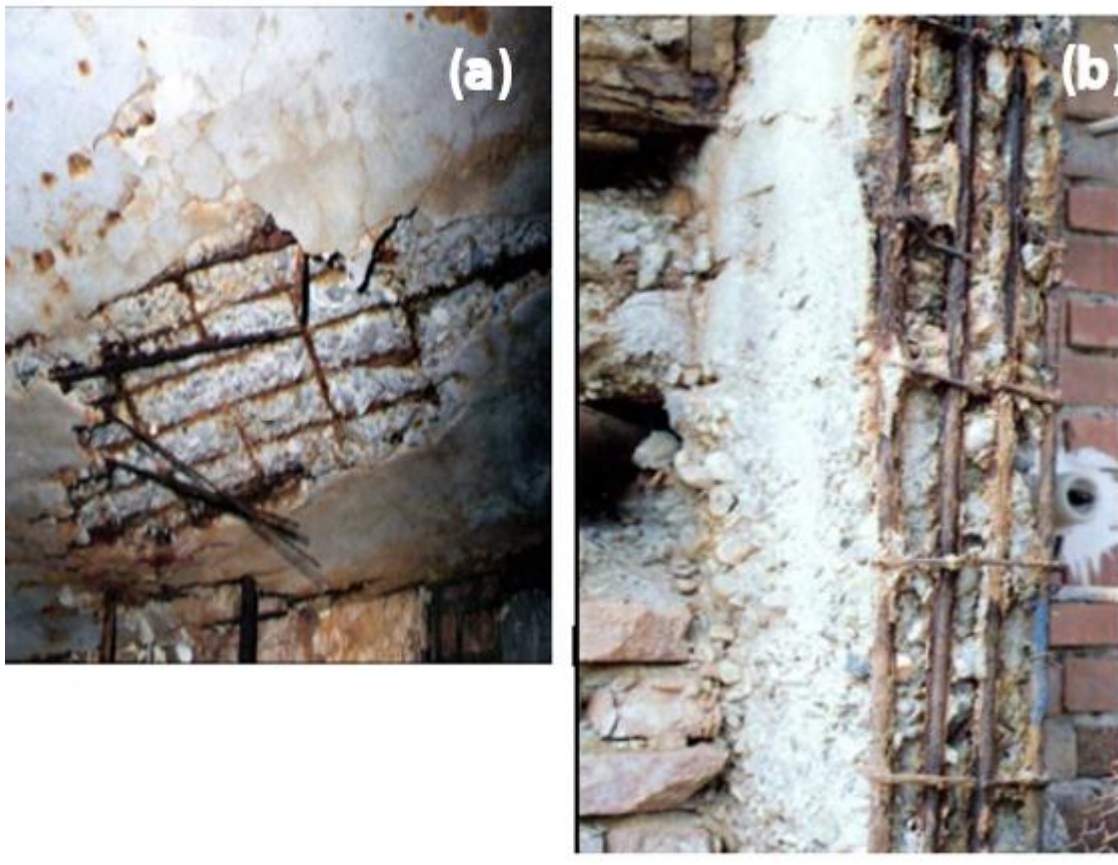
(a) Eclatement du béton d'enrobage d'un plancher, et (b) Dégradation d'un Poteau à cause de la corrosion avancée des barres d'armature (Pepenar, 2018).
